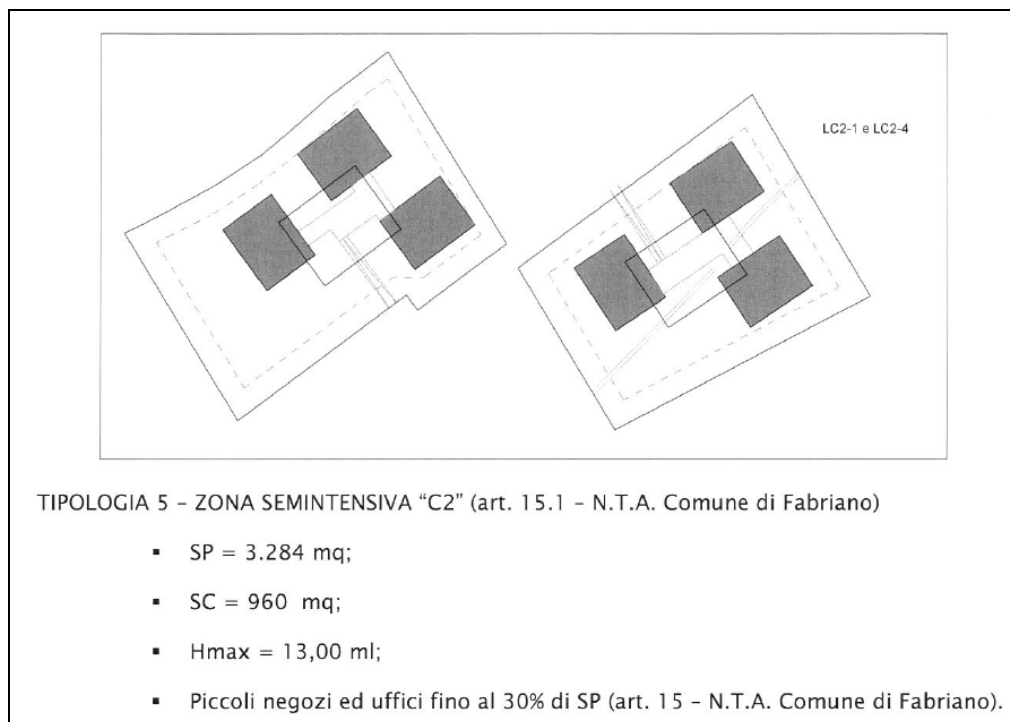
Estratto dalle N.T.A. in Variante al P.d.L. (Allegato 3)
